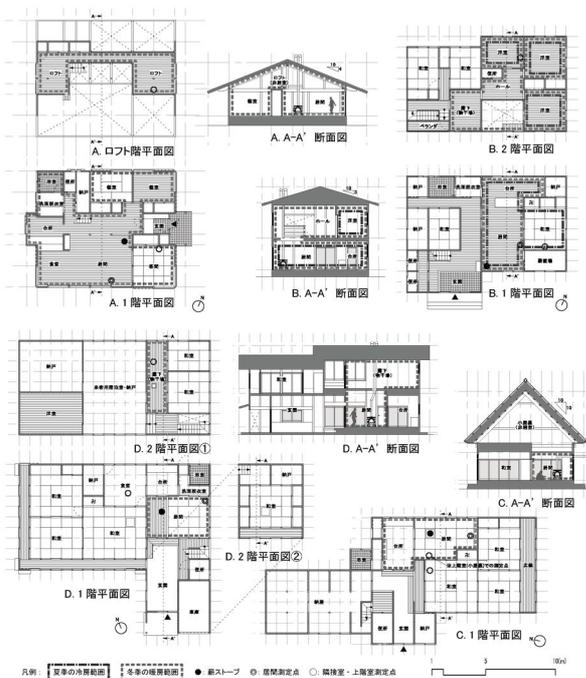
調査対象住宅の平面図、断面図、冷暖房範囲
